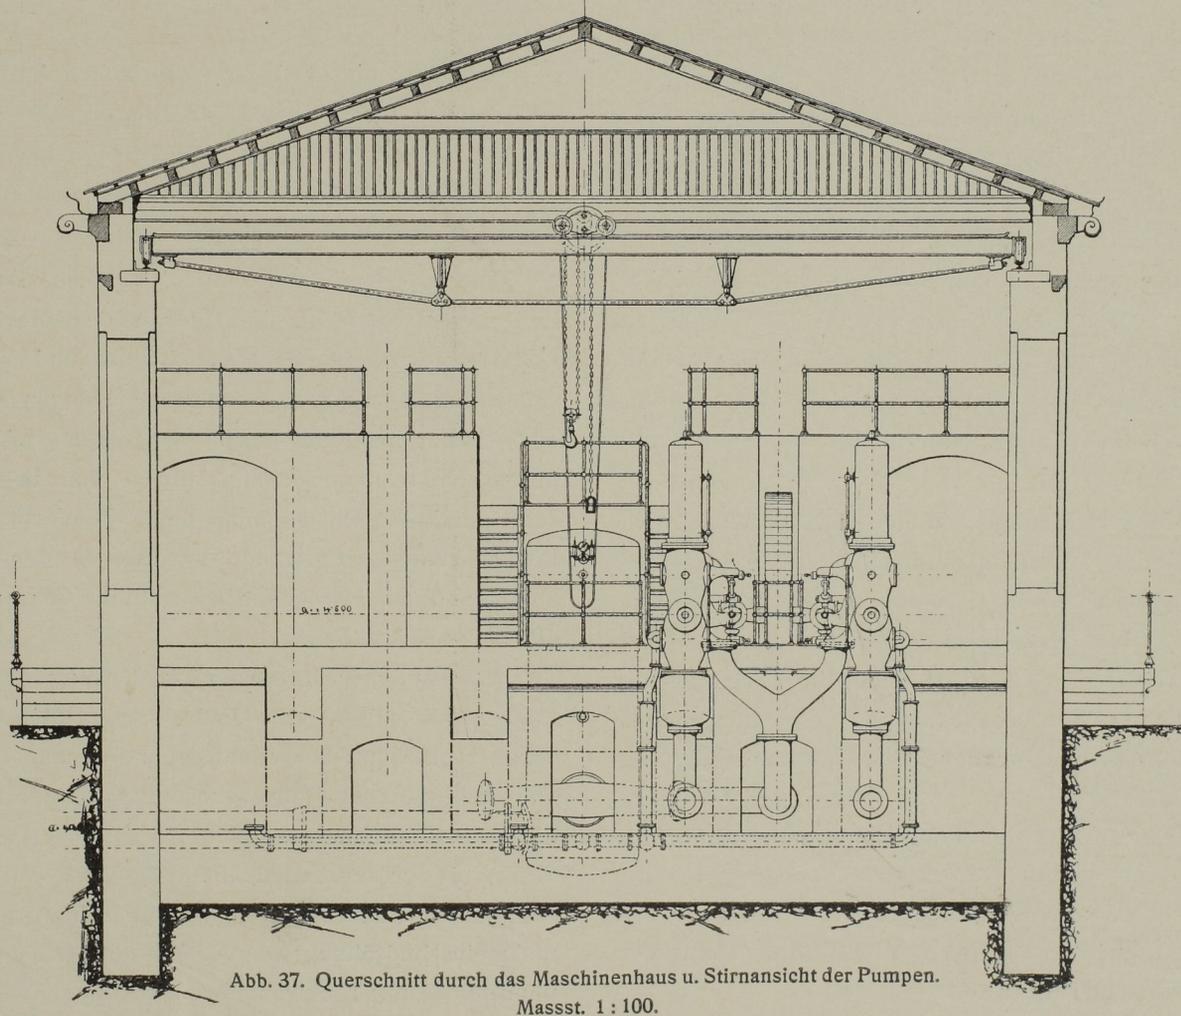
Querschnitt durch das Maschinenhaus u. Stirnansicht der Pumpen.
